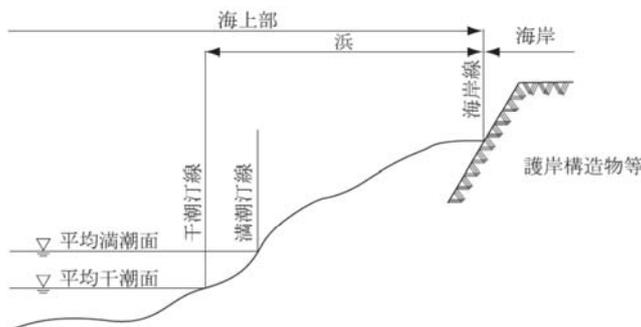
海岸線の位置 (道示Ⅲ編, 図-解 6.2.1)
